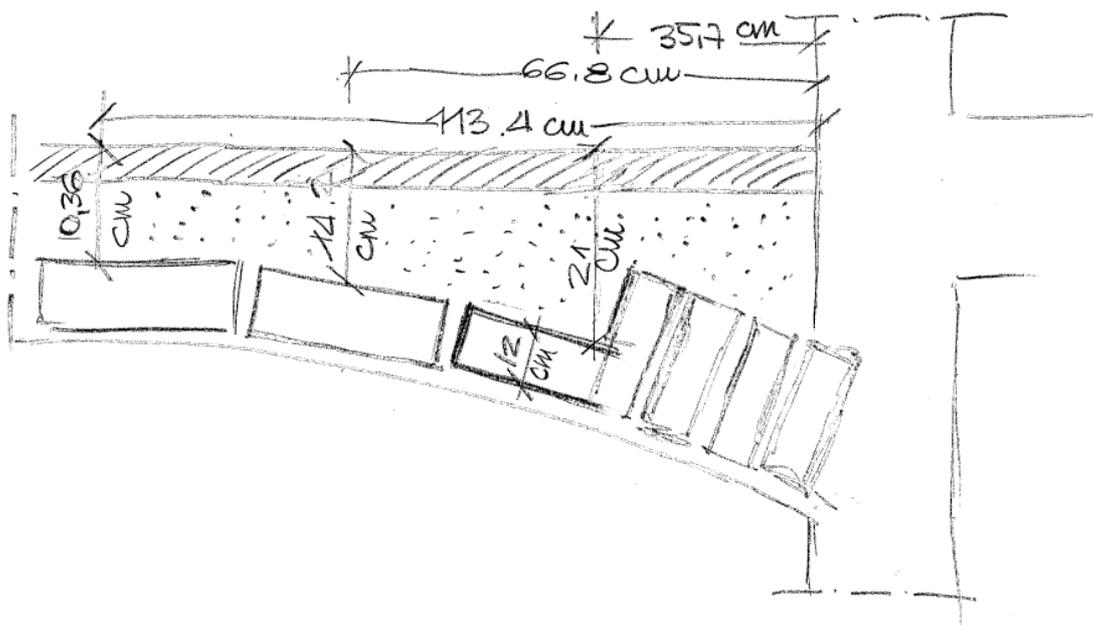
Dimensione e posizionamento degli elementi rilevati durante il sondaggio.
